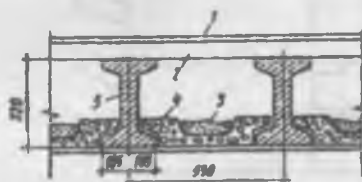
Конструкции для замены перекрытий с железобетонными прогонами швеллерного типа:
